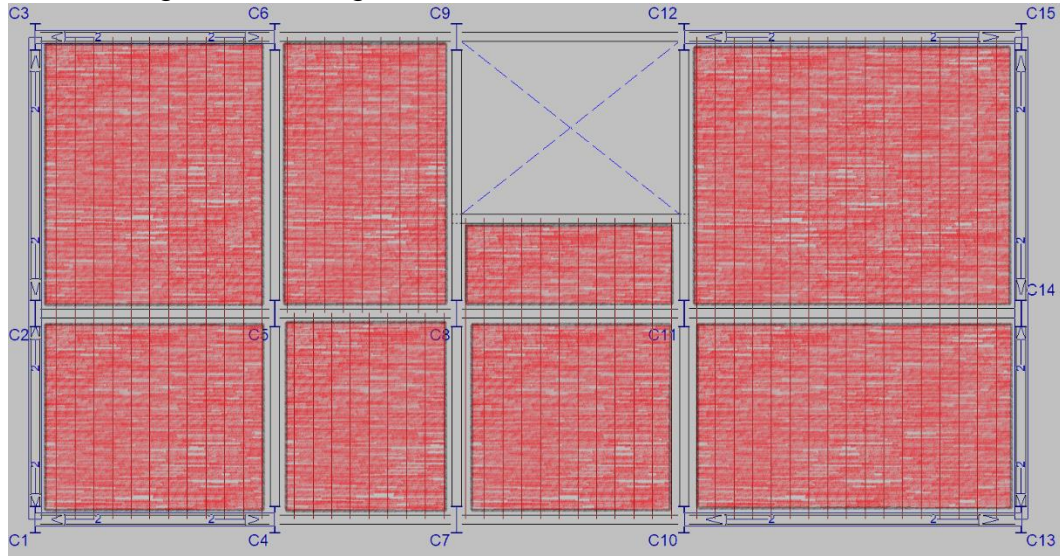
Losa aligerada con viguetas metálicas nivel 1
